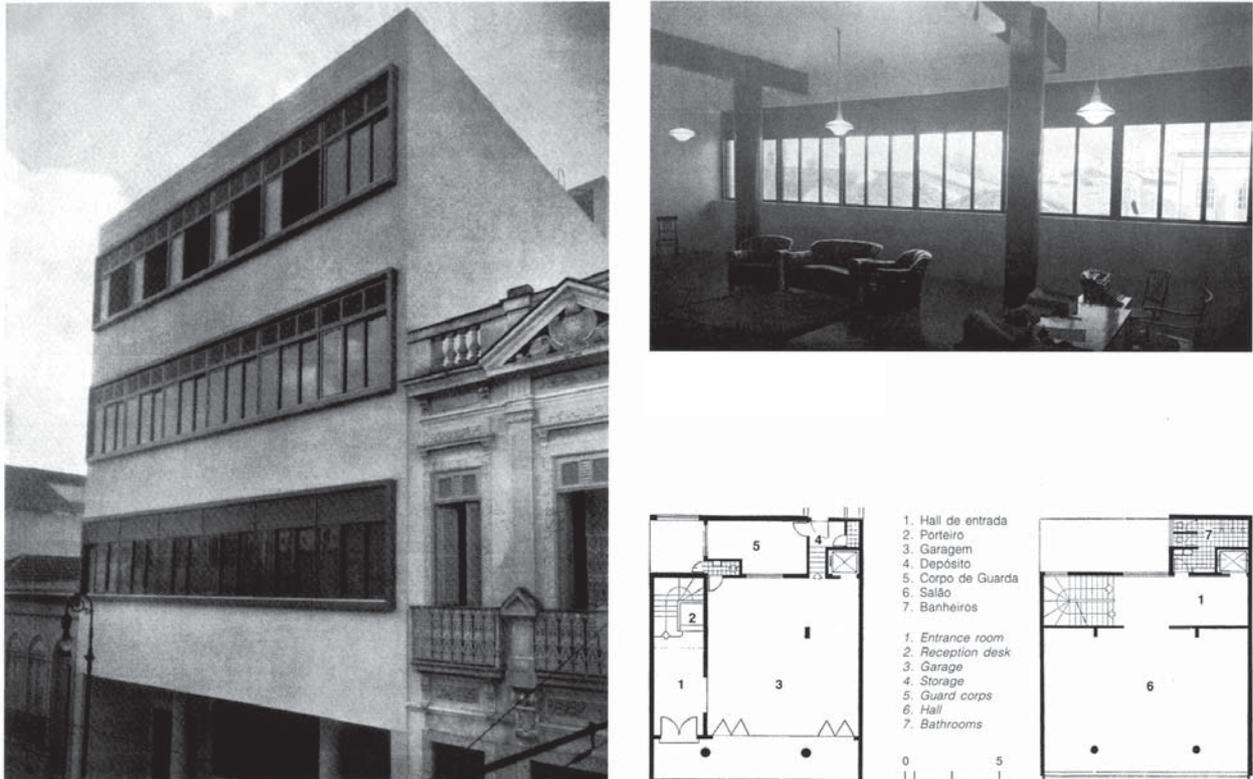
Affonso Eduardo Reidy, edifício-sede da Polícia Municipal, Rio de Janeiro, 1935. Vista externa, sala de trabalho e plantas do pavimento térreo e do pavimento tipo. Fonte: Bonduki (2000).
